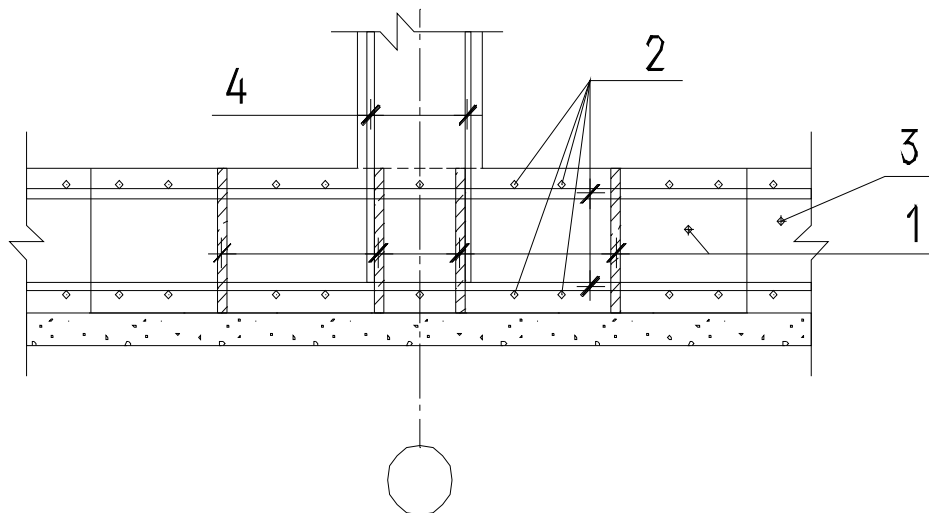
Сечение А-А: 1 – стальные листы; 2 – арматура периодического профиля; 3 – бетон; 4 – арматура колонны.
